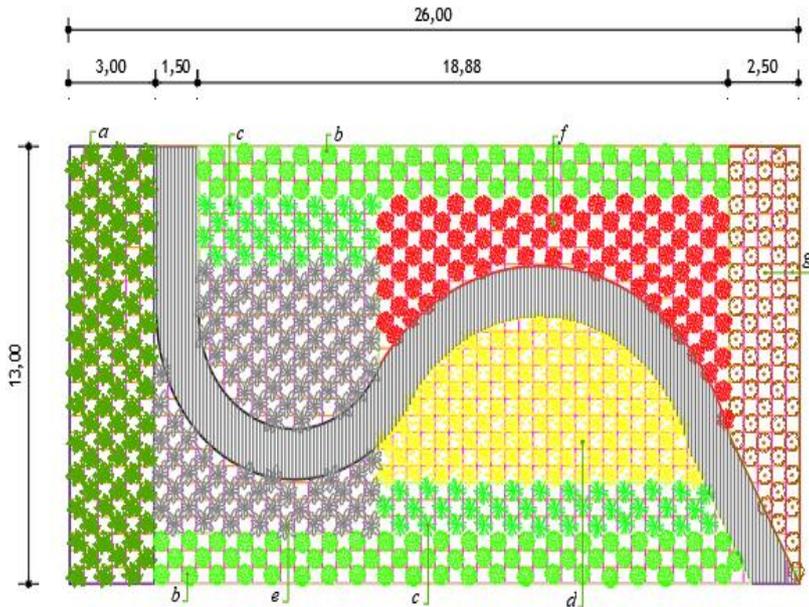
Disposição de plantio das mudas no projeto paisagístico proposto
